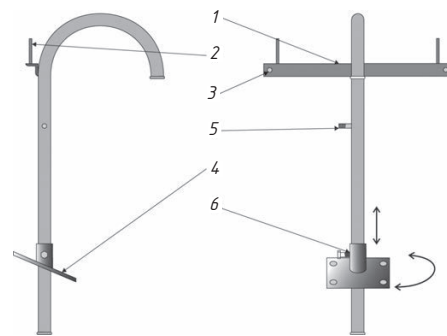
Гусак для установки на крышу: 1 — перекладина; 2 — штырьки для изоляторов; 3 — проушины для растяжек; 4 — кронштейн для крепления к стене; 5 — болт для заземления; 6 — фиксатор
